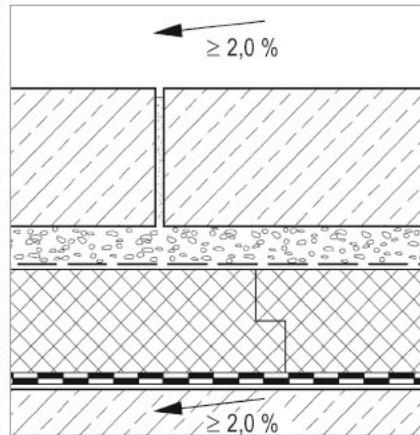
Typischer Parkdachaufbau mit großformatigen Ortbetonplatten als Umkehrdachkonstruktion [14]
